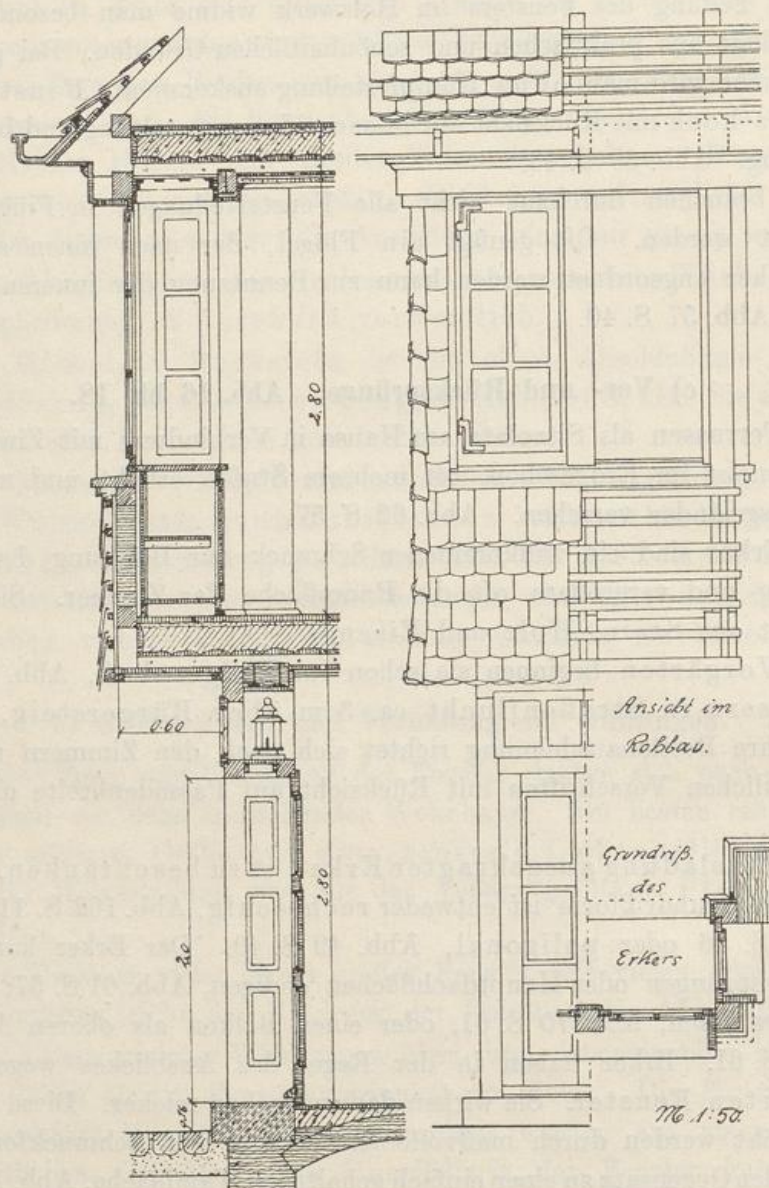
Erker in Holz konstruiert mit Dachziegelverkleidung.
